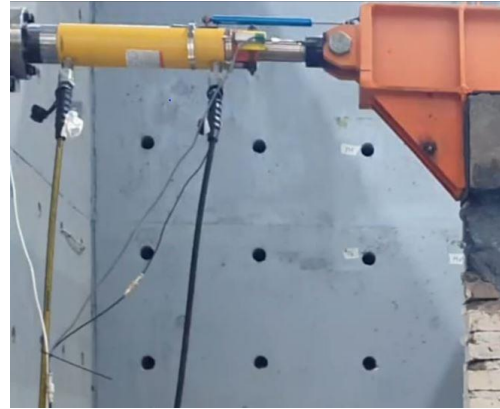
Disposición de LVDT (150 mm) sobre actuador y LVDT (25 mm) (Fuente: Elaboración propia)
